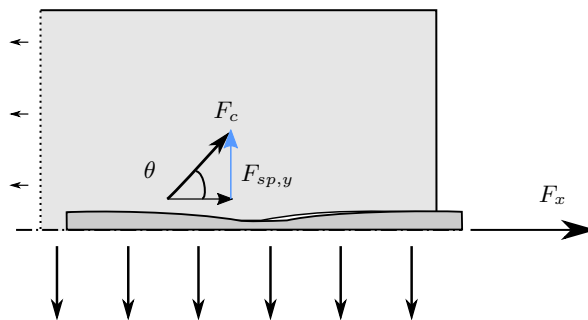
Neigung der resultierenden Betondruckstrebe zur Längsachse
